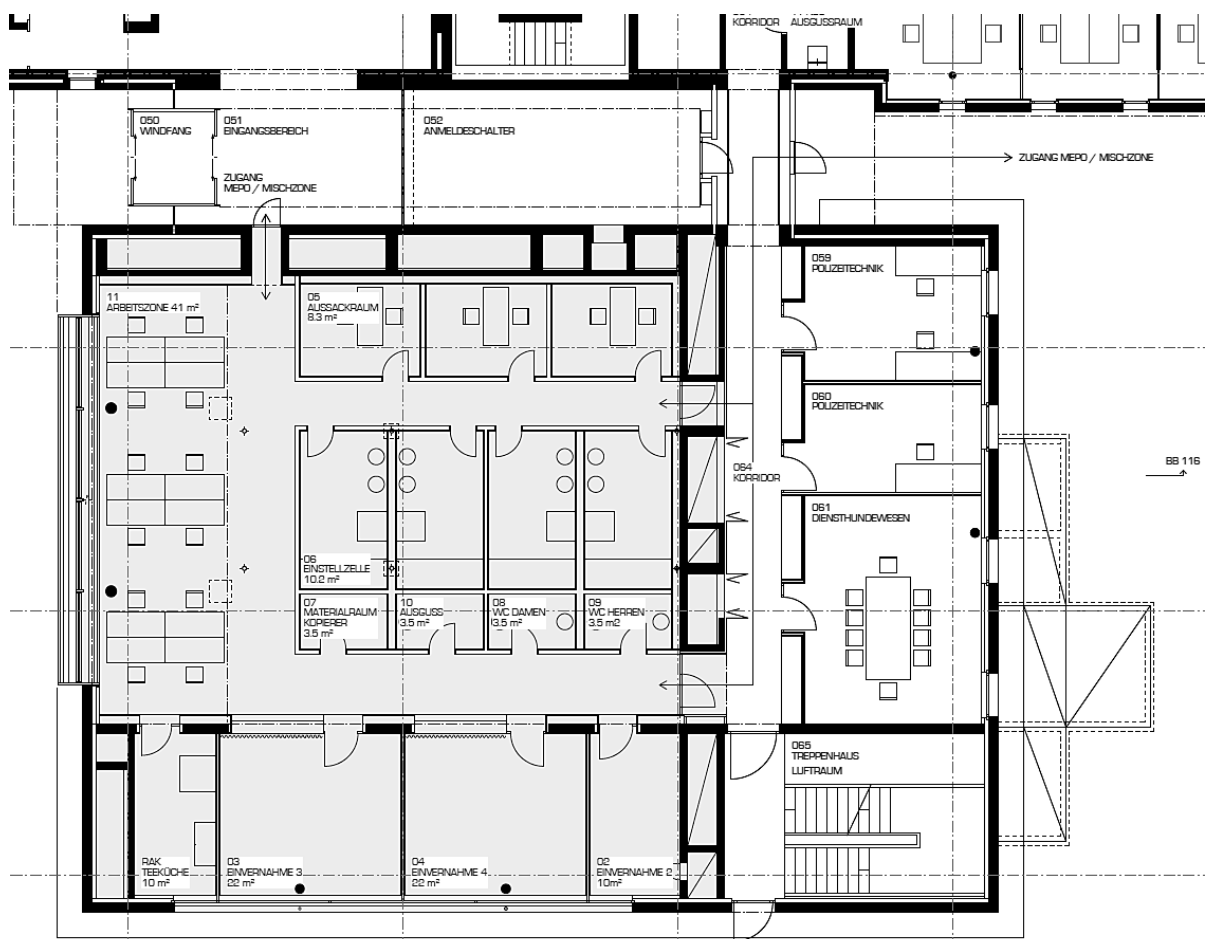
Grundriss Erdgeschoss ohne Massstab; Eingriffssperimeter graue Fläche
